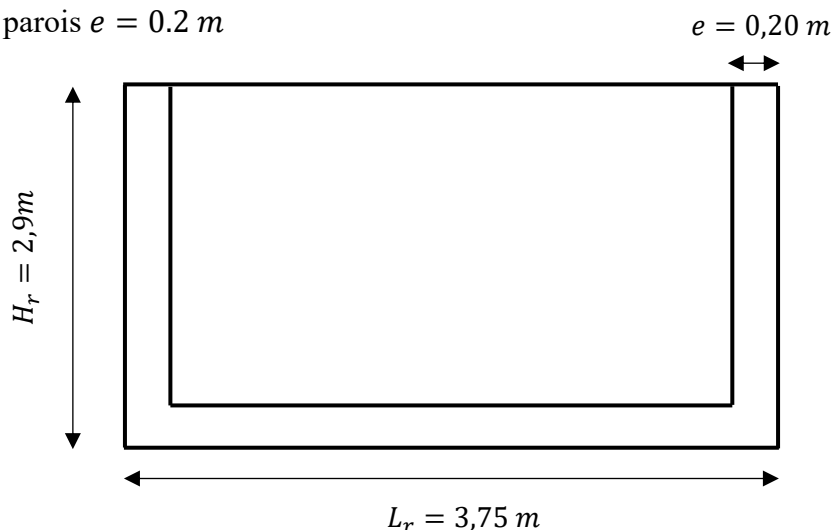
coupe en élévation de réservoir en béton armé.
